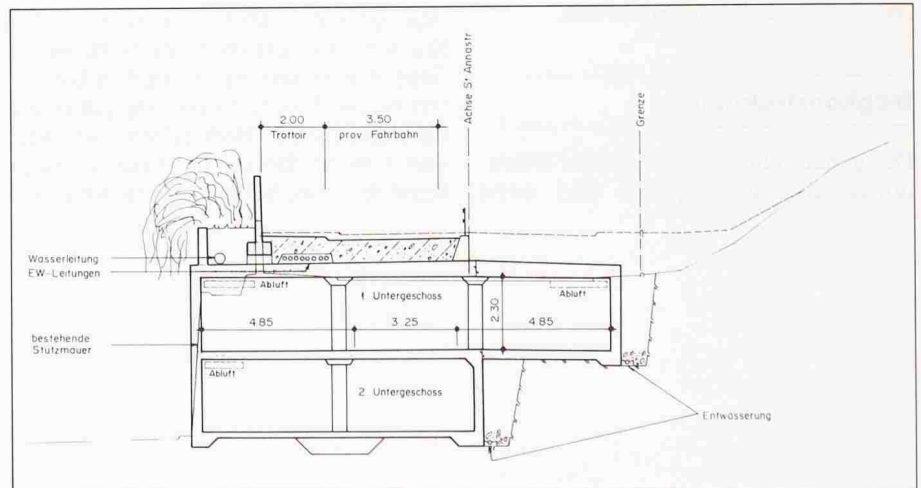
Schnittplan 1:100 der 2. Bauetappe
